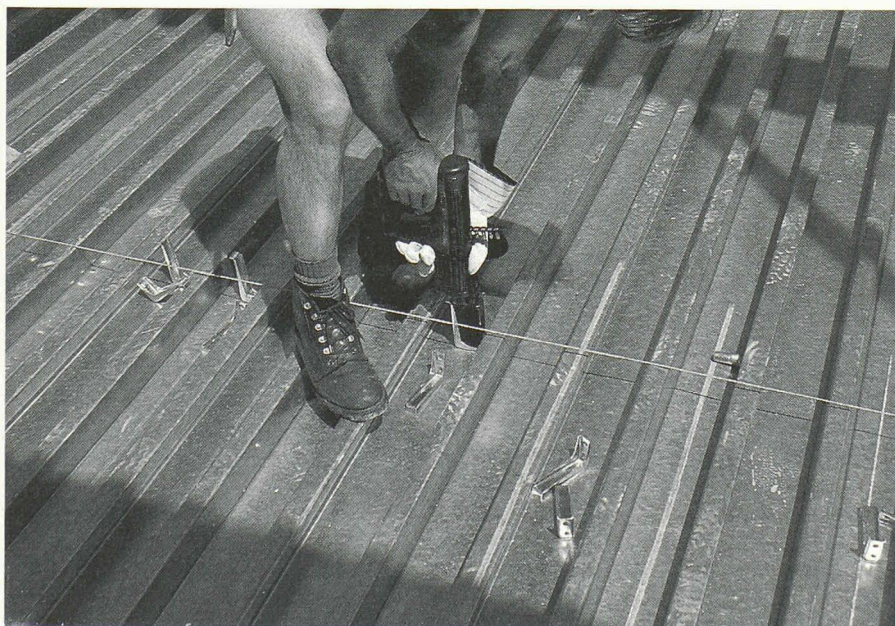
Chantier de l'EPFL à Ecublens. Vue de la pose des connecteurs Hilti HVB 105 lors de la construction d'un bâtiment à charpente métallique avec planchers mixtes acier-béton. Entreprise : Geilinger SA, Yvonand. Bureau d'ingénieurs : Matter Ingénieurs SA, Lausanne.
